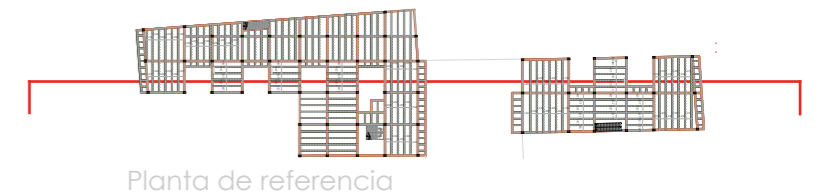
Distribución de columna, vigas y viguetas. Nota. Elaboración propia.
